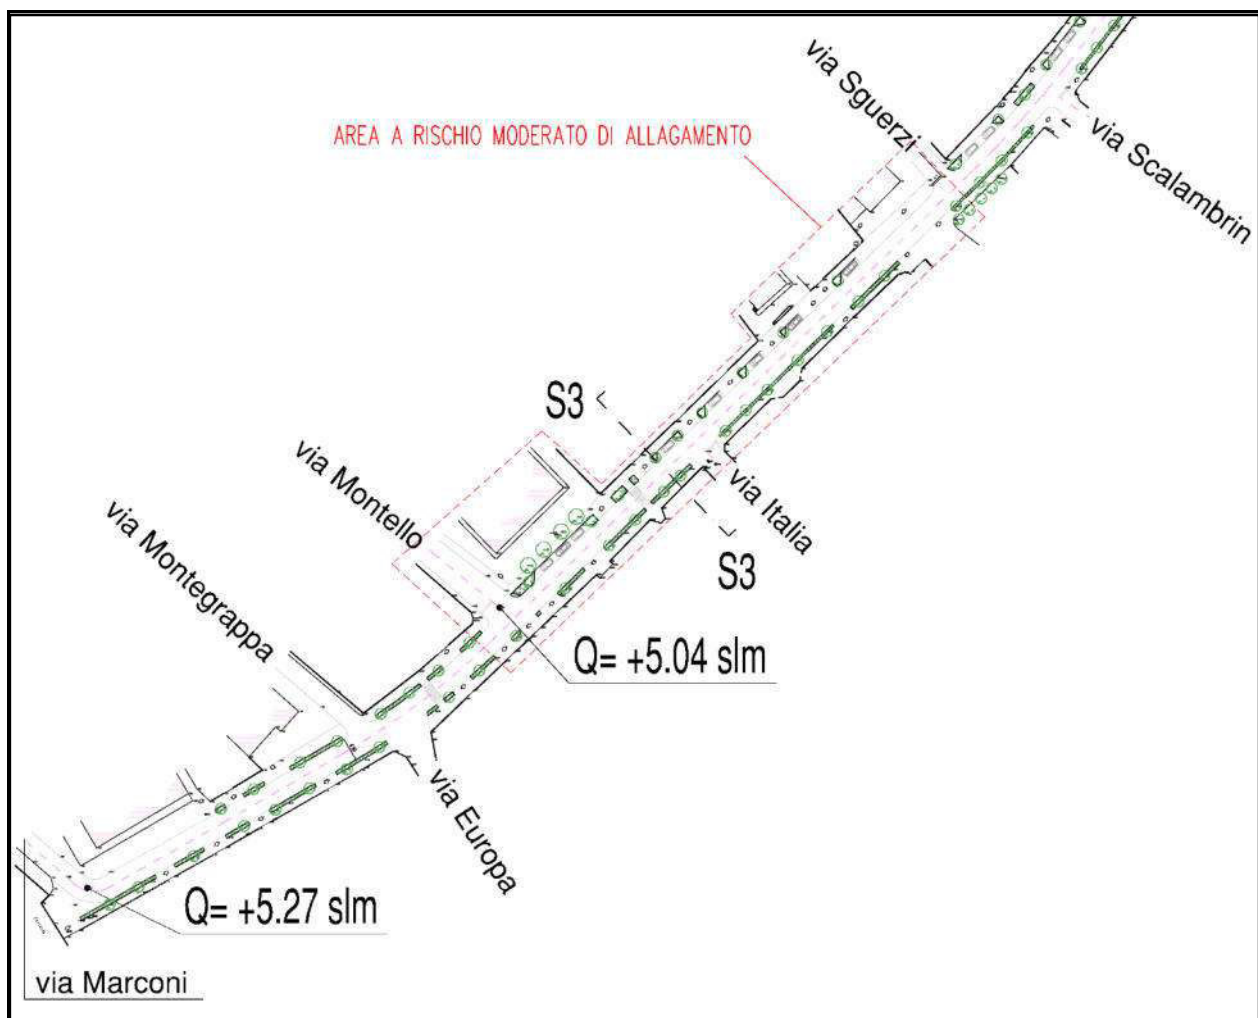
Estratto della planimetria di progetto con indicazione dell'area a moderato rischio di allagamento
